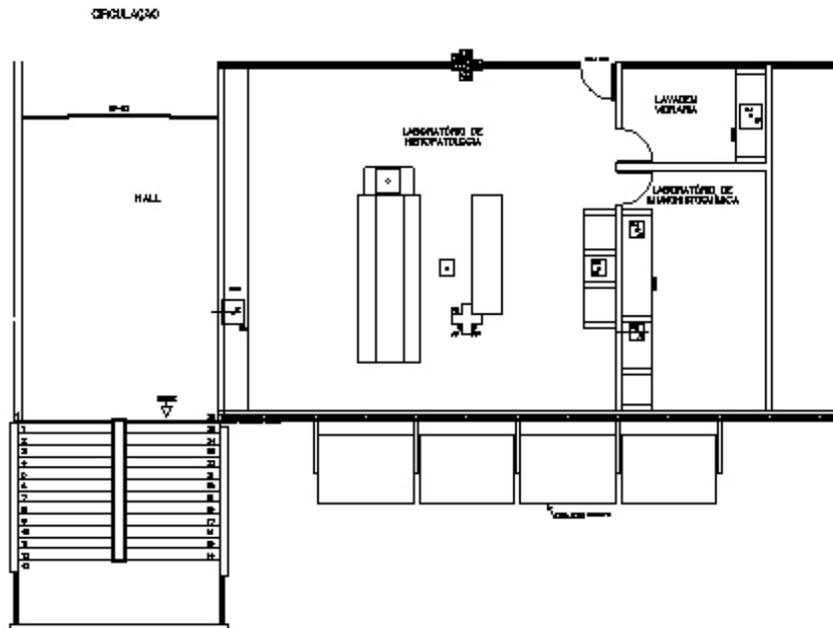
Planta da reforma do laboratório de histopatologia – segundo pavimento
